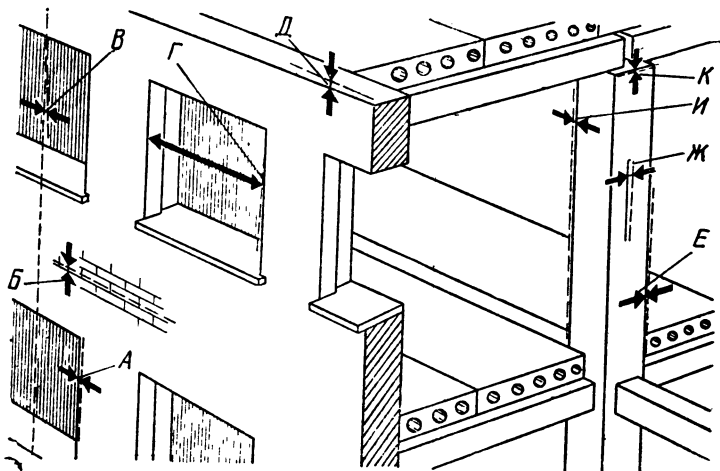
Схема измерения отклонений при кладке наружной стены и столба из бетонных и керамических камней правильной формы:
